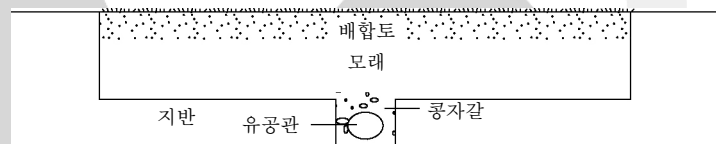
모래층지반(thin rootzone-two layer system)
